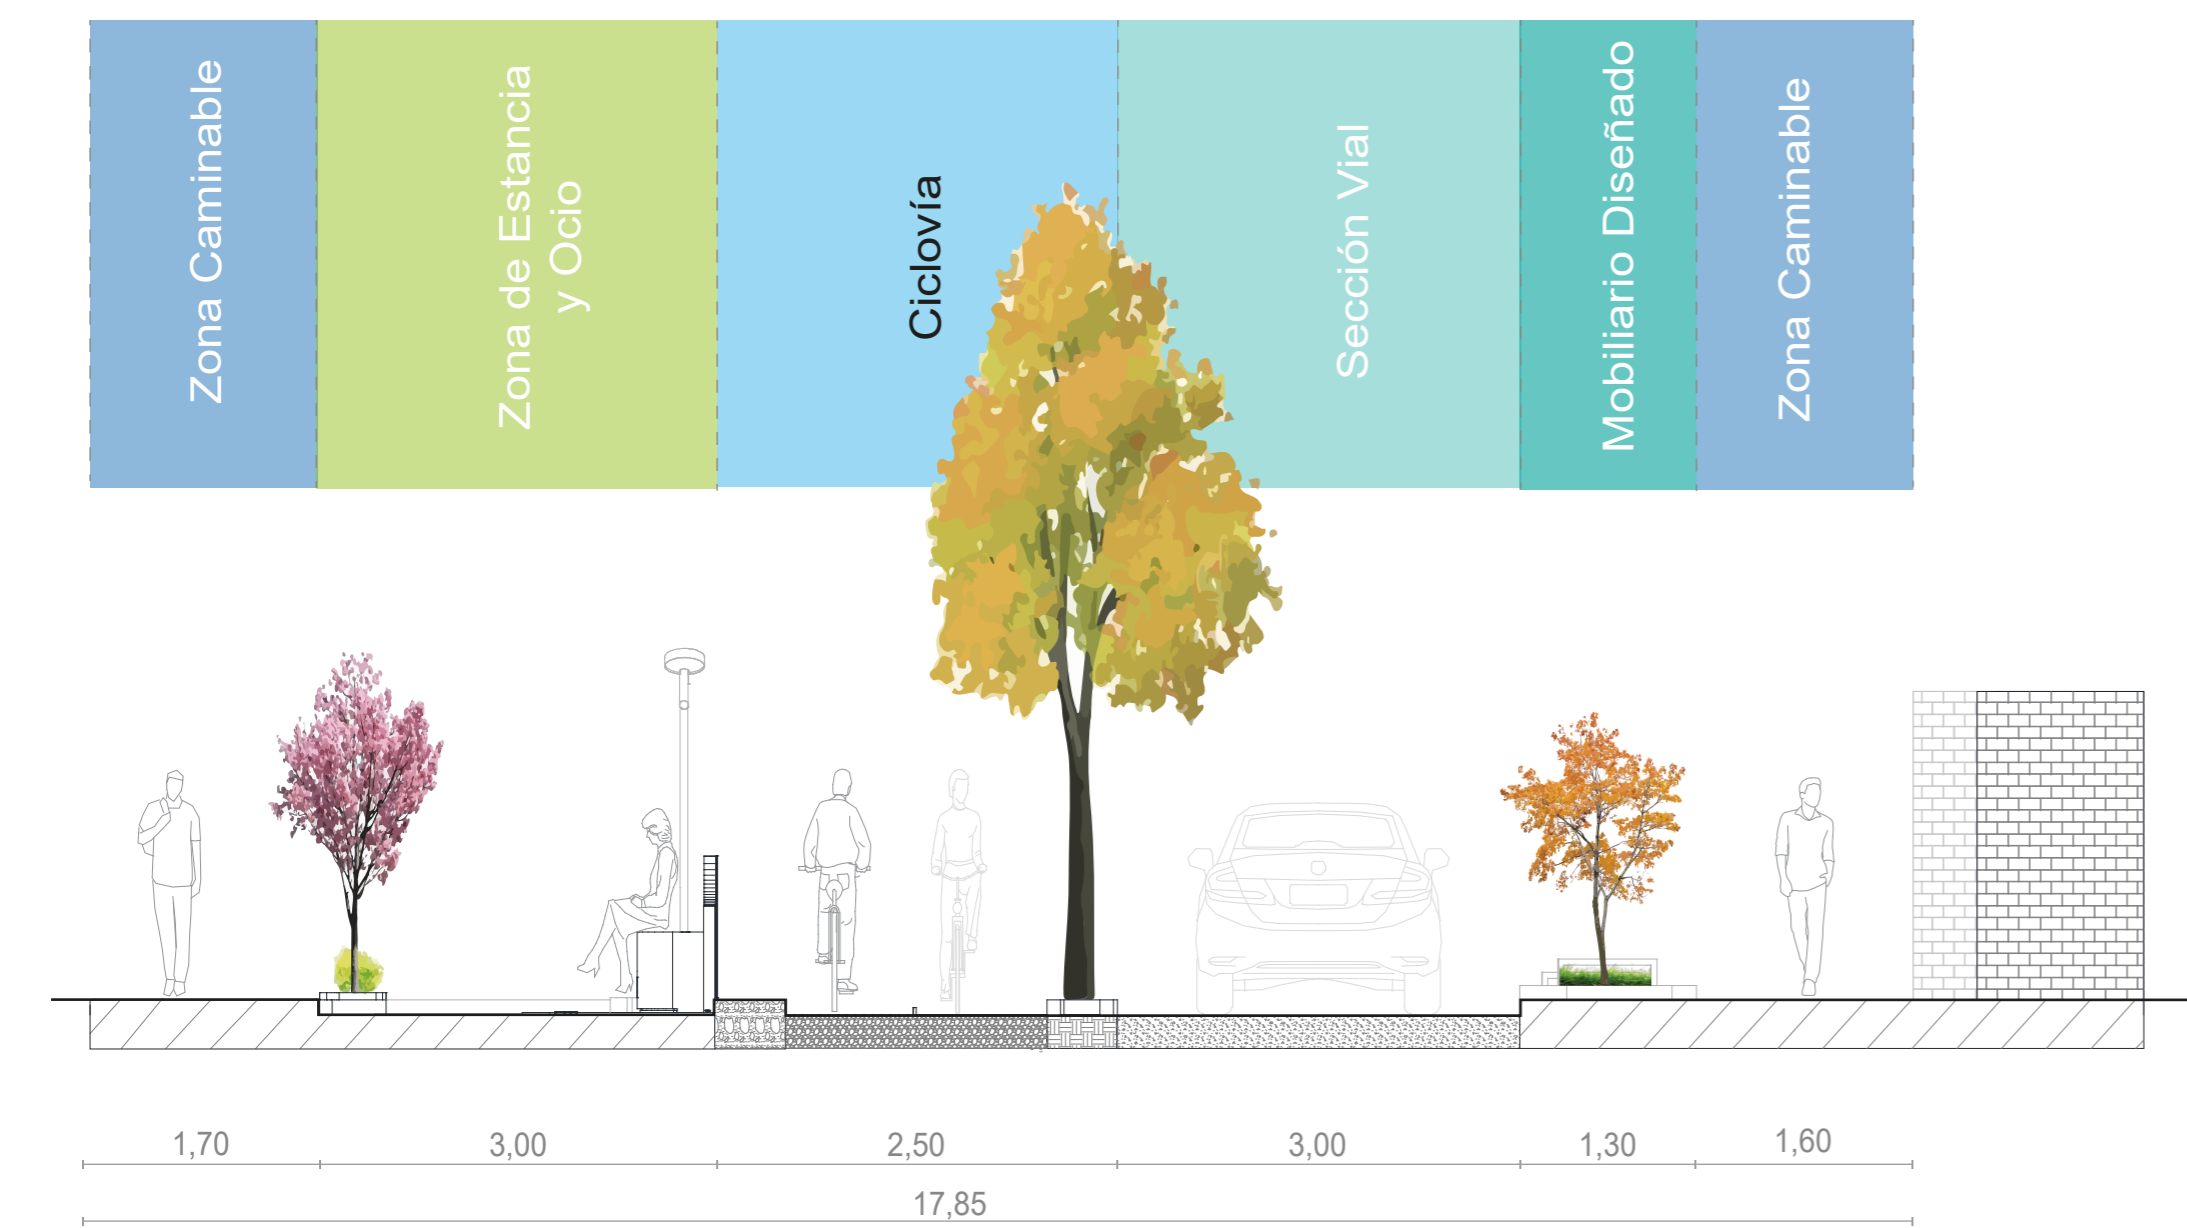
Planta-Sección de la propuesta en el Tramo 3
